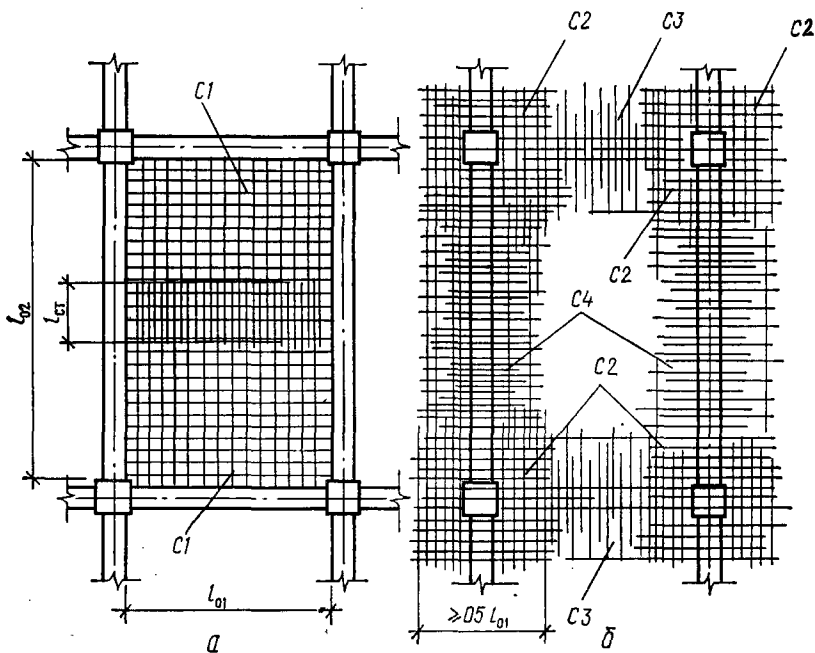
Вид армирования плиты, опёртой по контуру:
